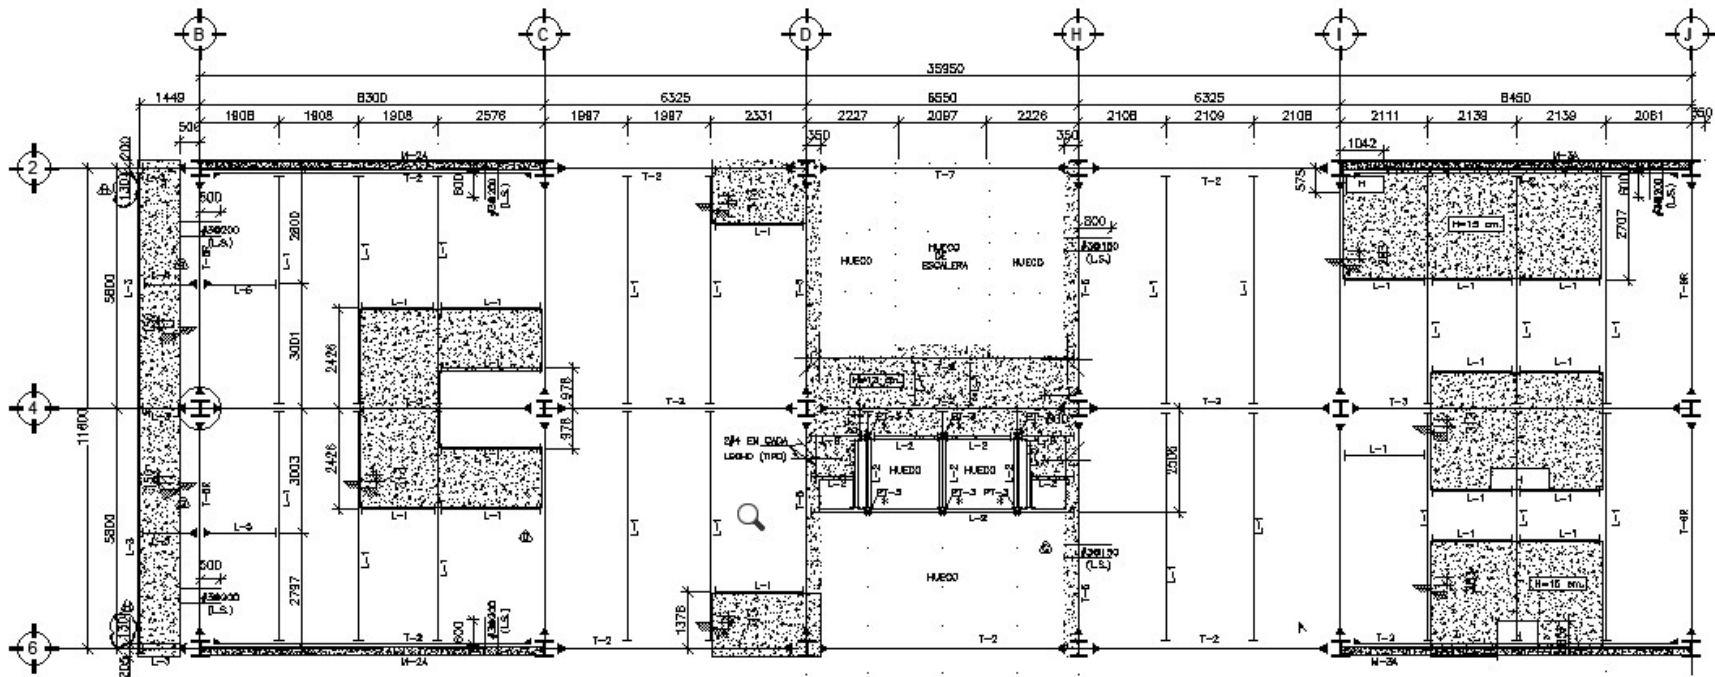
Planta estructural del edificio a base de Estructura Metálica.
